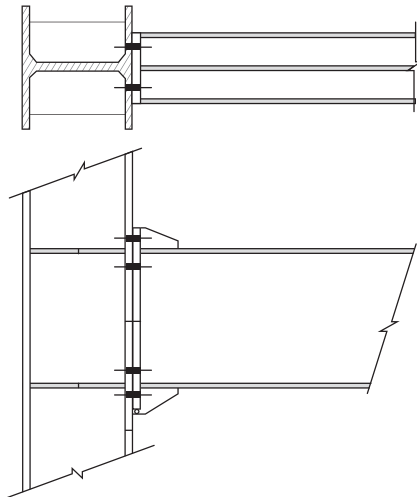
Assemblage d'une poutre dont la section est affaiblie
